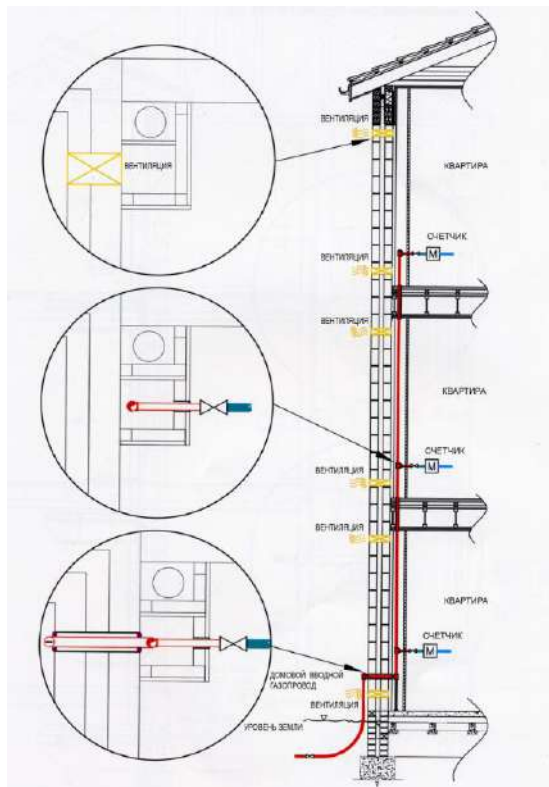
Газопровод в вентилируемой штрабе
